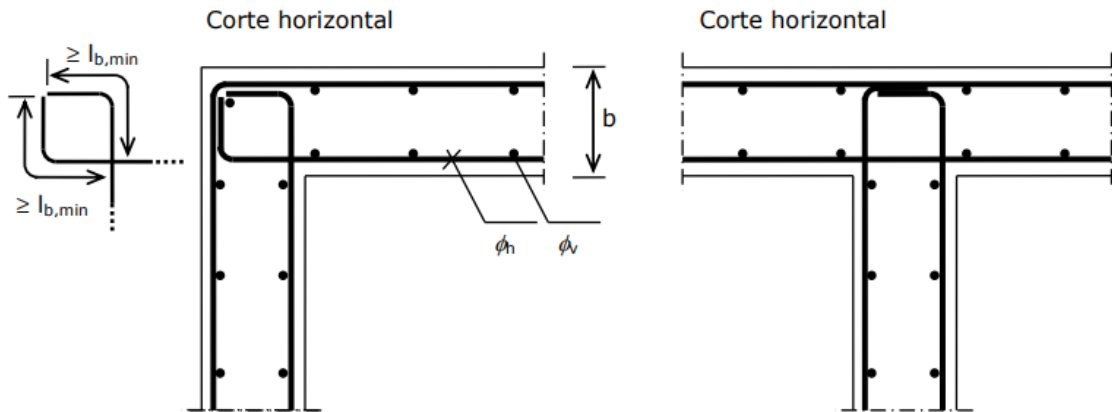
Amarração da armadura horizontal nas zonas dos cantos (Félix, et al., 2014)
